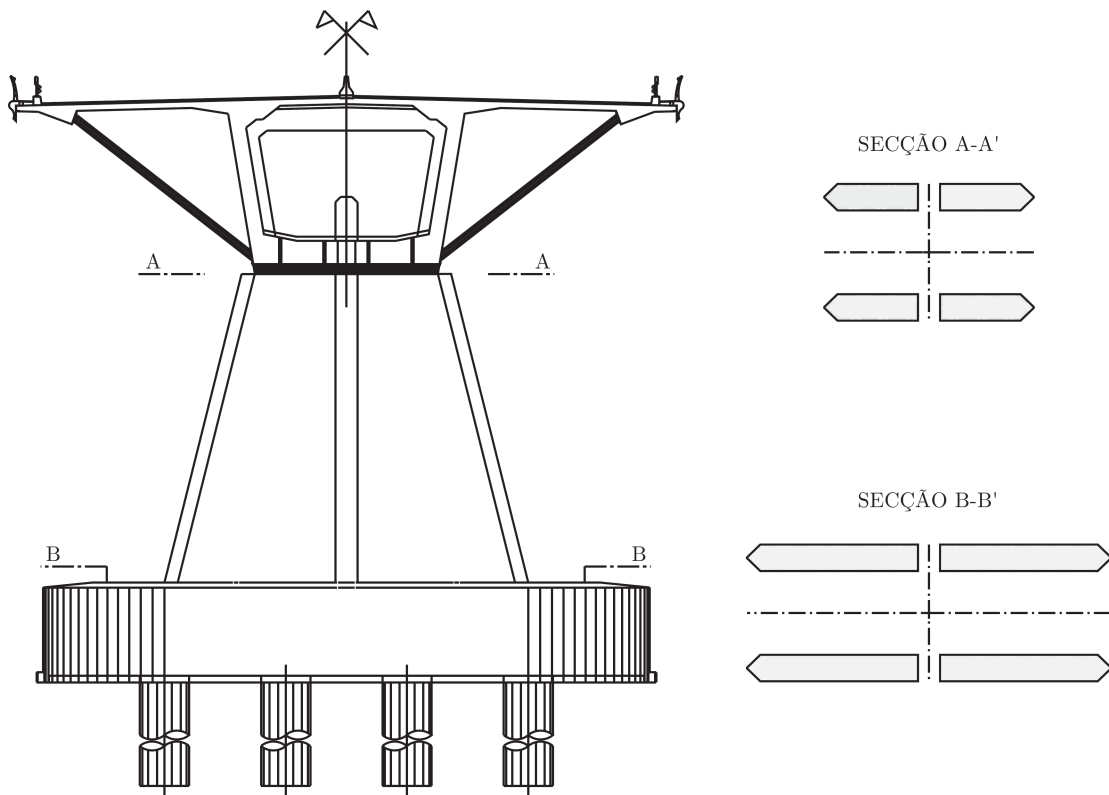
Secção transversal tipo dos pilares da Ponte da Lezíria.
